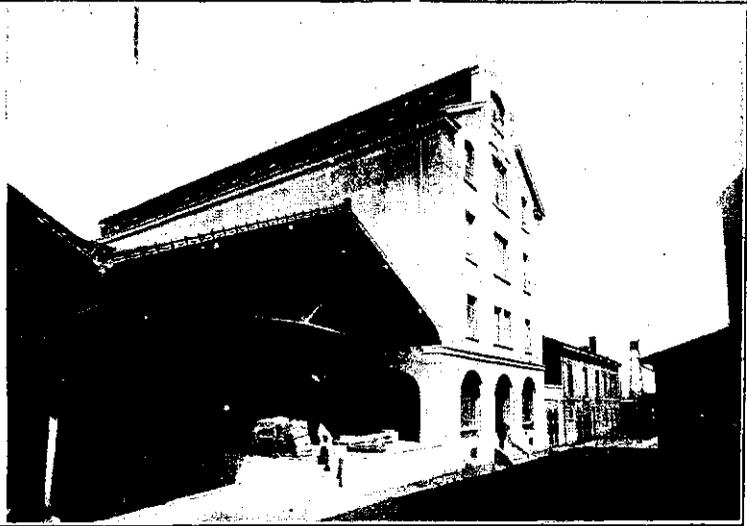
Vue d'un silo achevé, façade sur cour d'usine.
